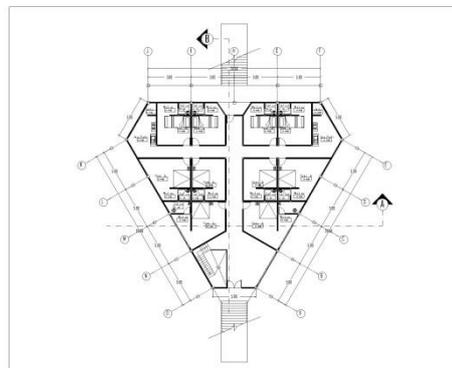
Denah Lantai 1 Ged. C (Pusat Pembinaan, Peng. dan Penelitian)
